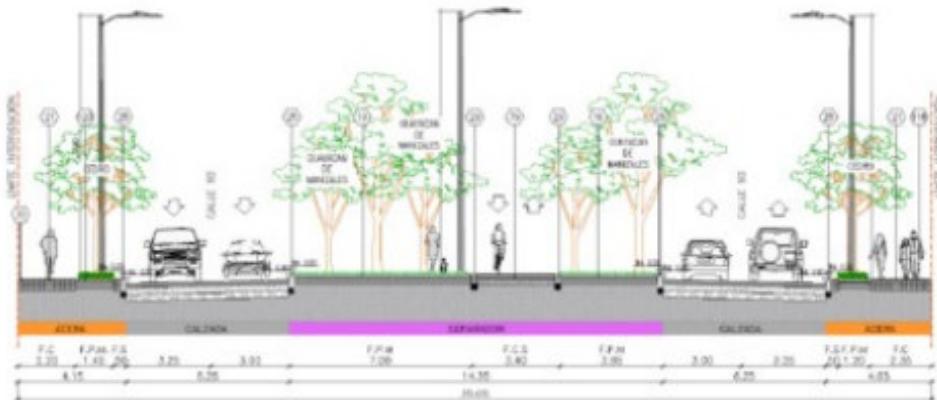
Perfil propuesto tramo Calle 92 entre Cra.11 y NQS
